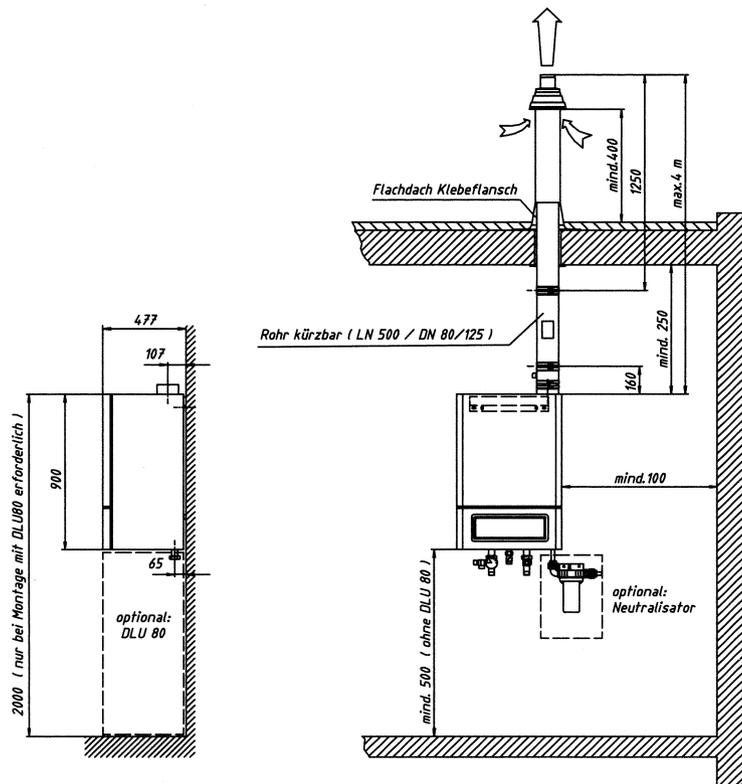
Einkesselanlage in Gebäuden, raumluftunabhängig als Flachdachdurchführung
